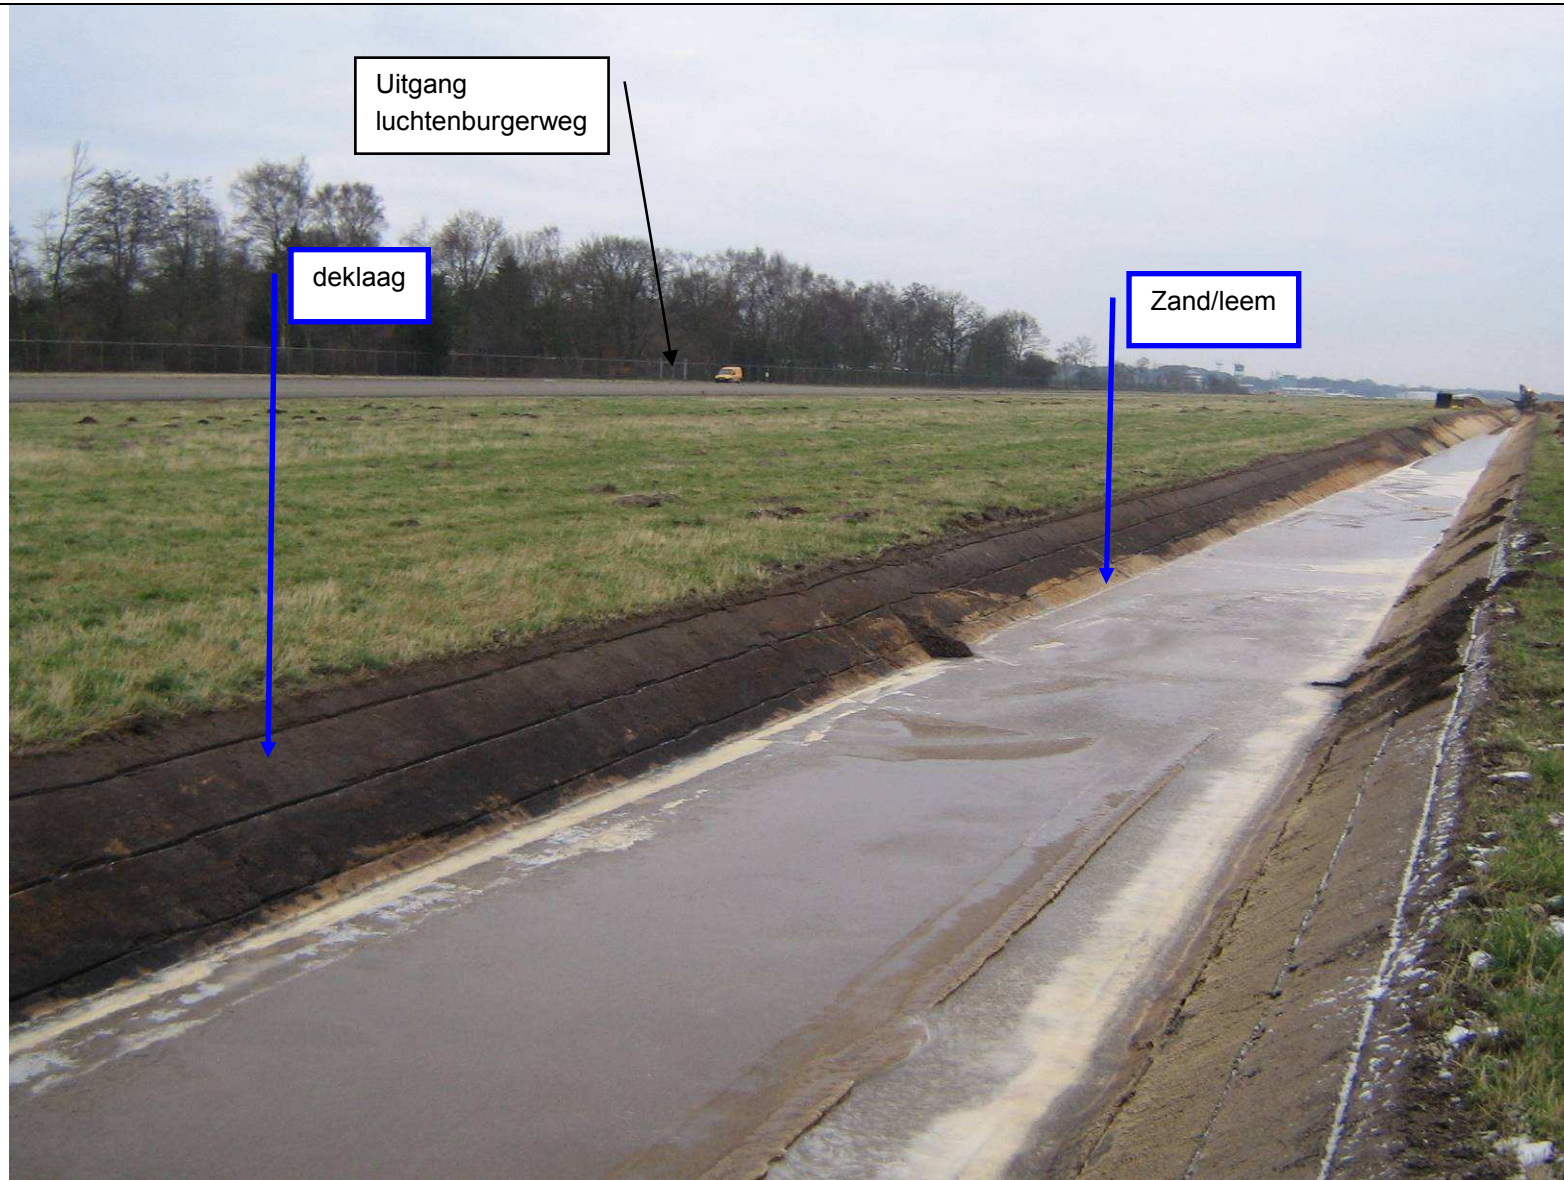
; Beekdal Runsloot Oost, Sectie C, Pand 2
